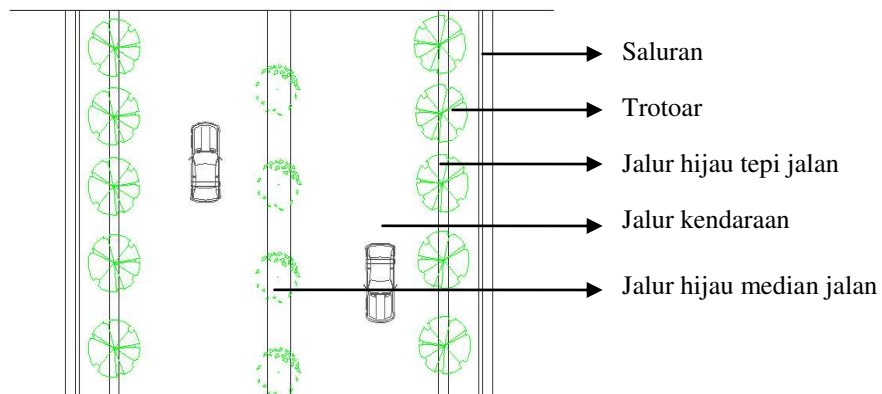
Layout Jalur Hijau Tepi Jalan Brigjen Piola Isa
